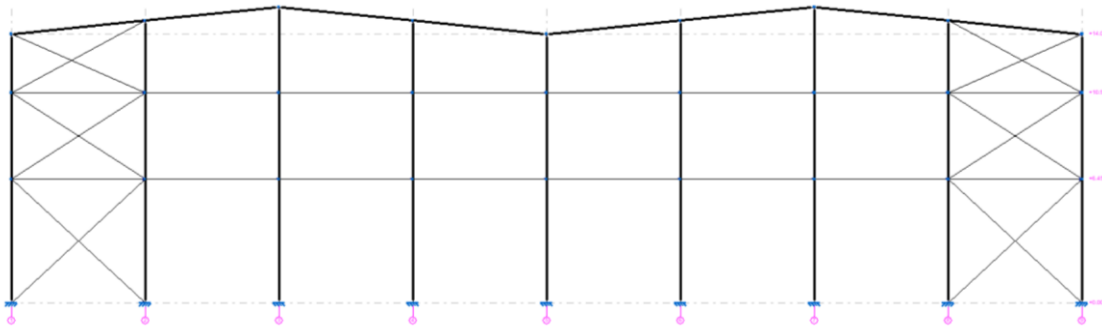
Dos de los cuatro pórticos de fachada. Fuente: CYPE
